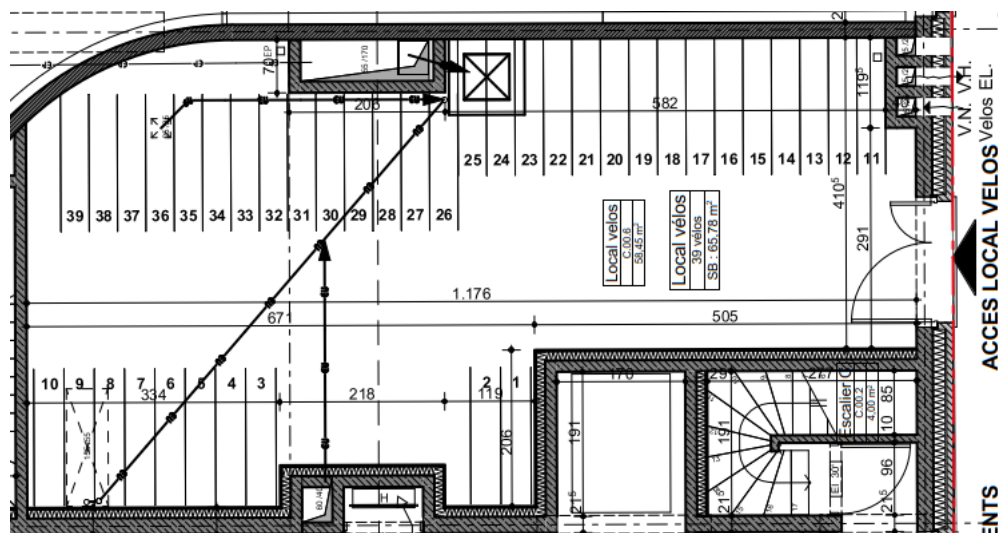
Accès au local vélo du bâtiment 2 (source : plans PU)
